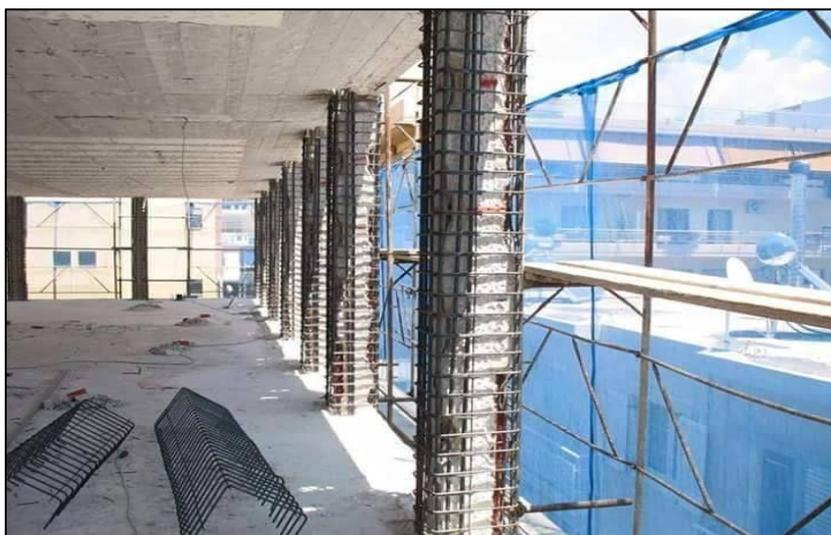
Reforzamiento mediante encasado de concreto reforzado
